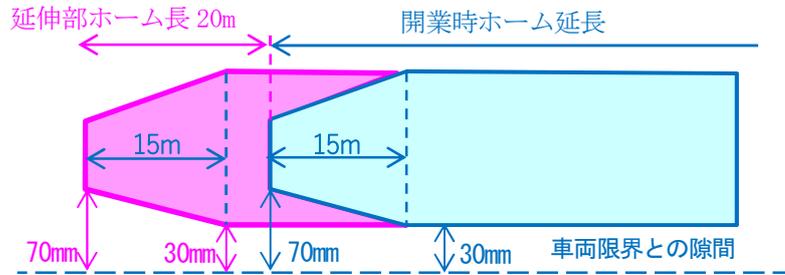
プラットホームの建築限界の拡幅平面図
